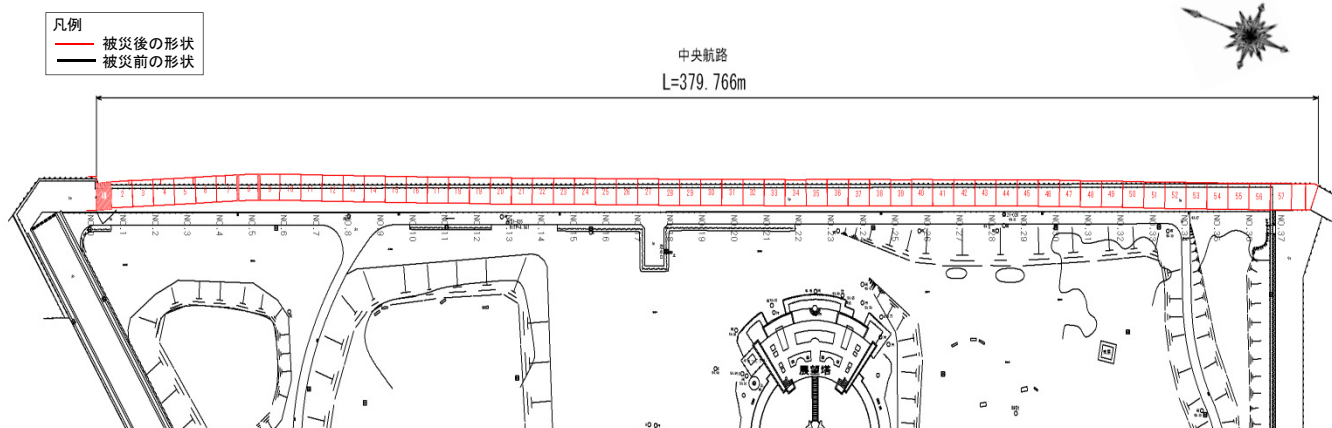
26 No. 3 中央船溜消波護岸の平面図 (被災前後)
